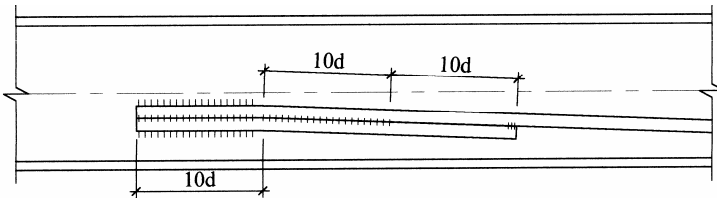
Узел крепления арматуры к стенке балки (патент Украины №59242А)
